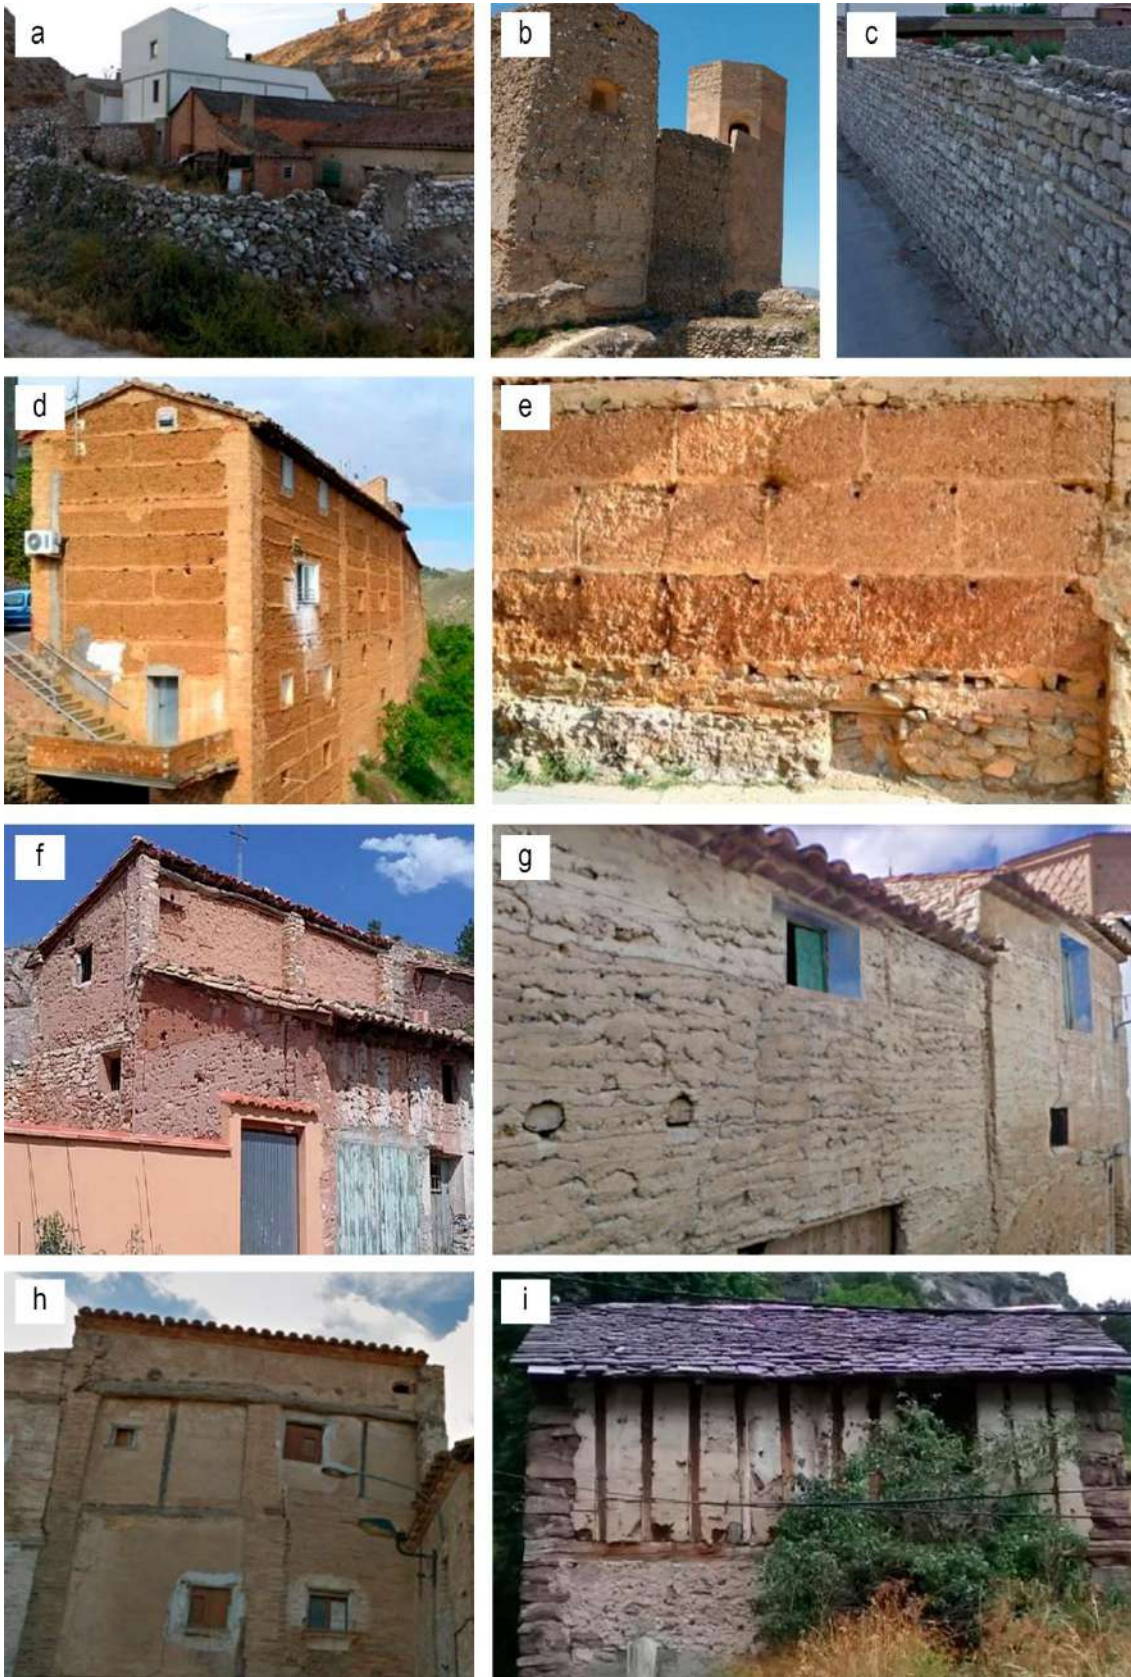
a) Muros de piedra en seco en Rodén (Zaragoza). Muros de piedra con hormigón de yeso vertido en b) Calatayud (Zaragoza) y c) Farlete (Zaragoza). d) e) Muros de tapia en Moros (Zaragoza). Muros de encofrado de hormigón de yeso vertido en f) Montalbán (Teruel) y g) Belmonte de Gracián (Zaragoza). Muros de entramado de yeso vertido en h) Borja (Zaragoza) y i) Gistaín (Huesca). Fotografías del autor.
